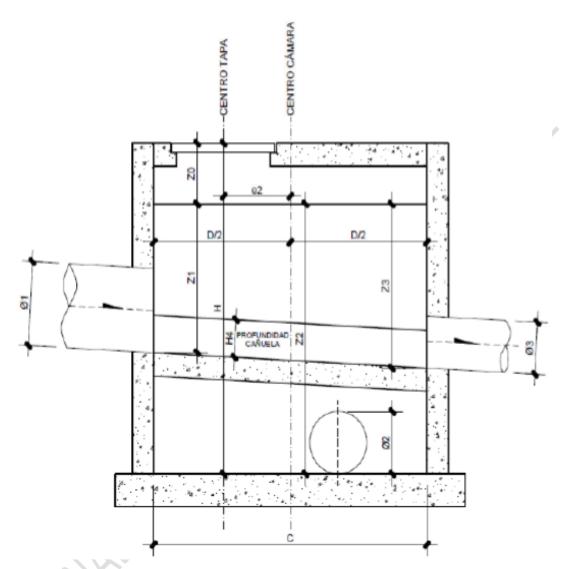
Vista en perfil del aliviadero de cañuela elevada en caja.
